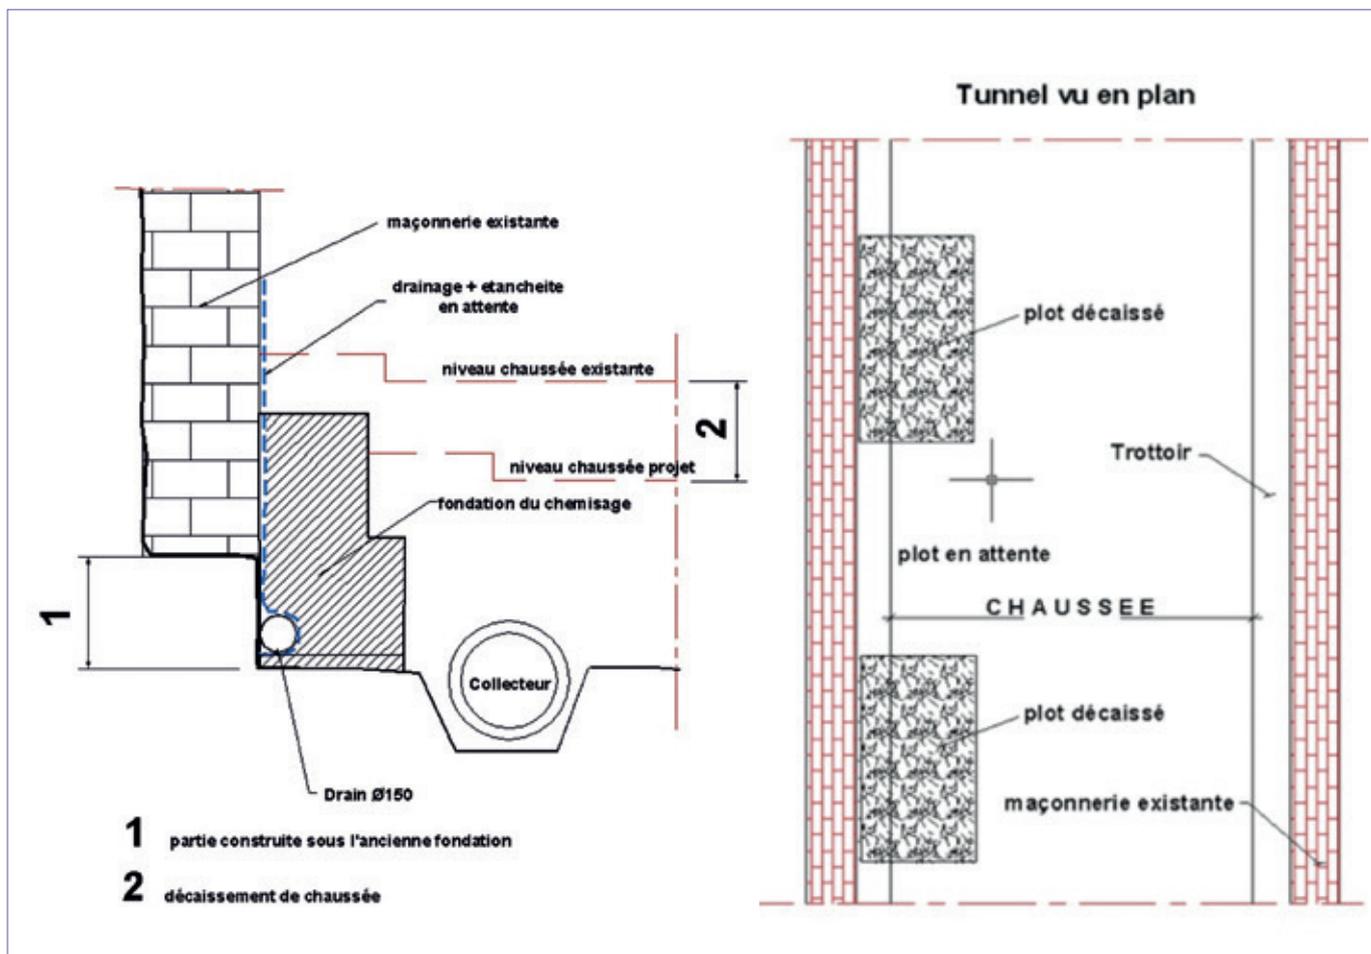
Coupe sur nouvelle fondation et travaux par plots alternés
